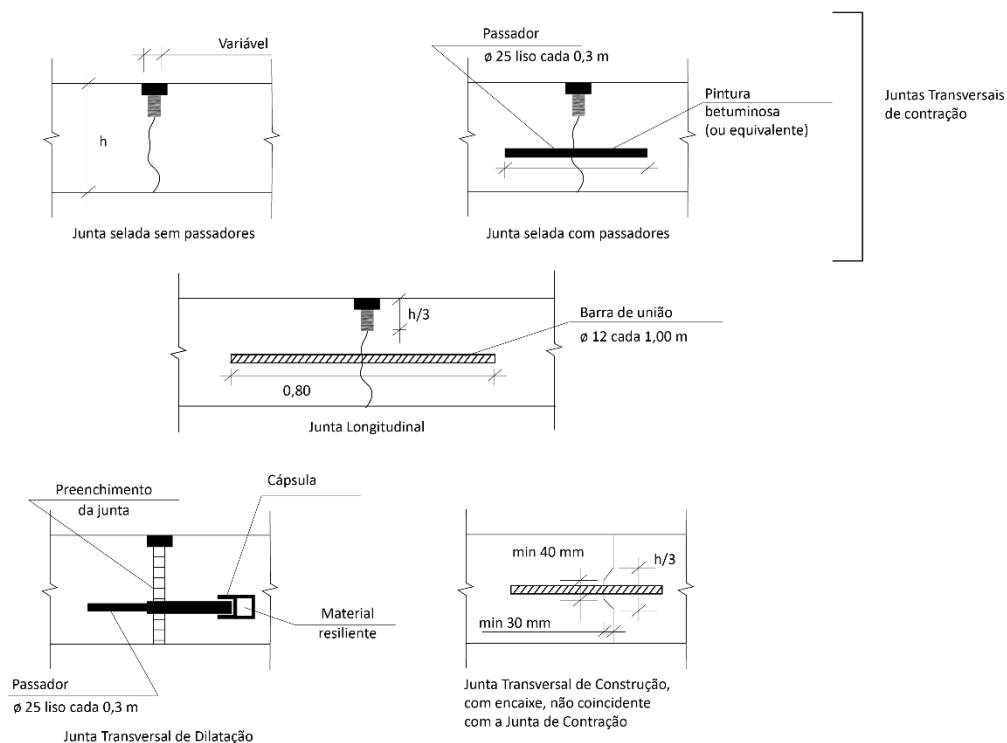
Tipos de juntas e passadores em pavimentos rígidos (adaptado de BRANCO, 2008)
